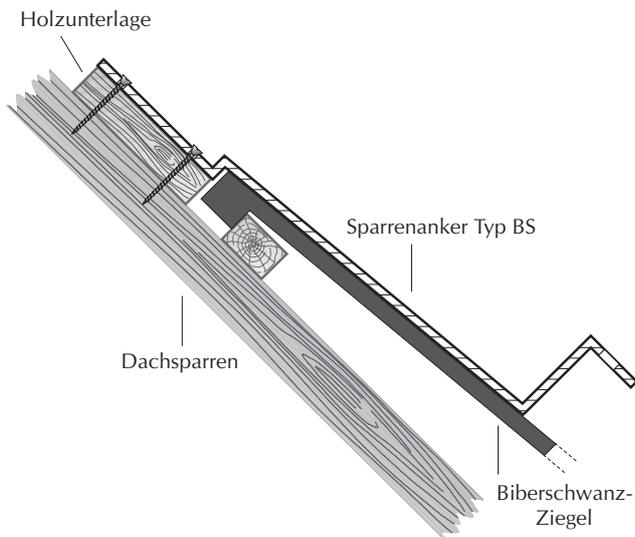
Zur Montage von Typ „S“ erst Holzunterlage in Dachlattenstärke auf Dachsparren fixieren, dann Sparrenanker positionieren und mit Spax-Schrauben befestigen.
